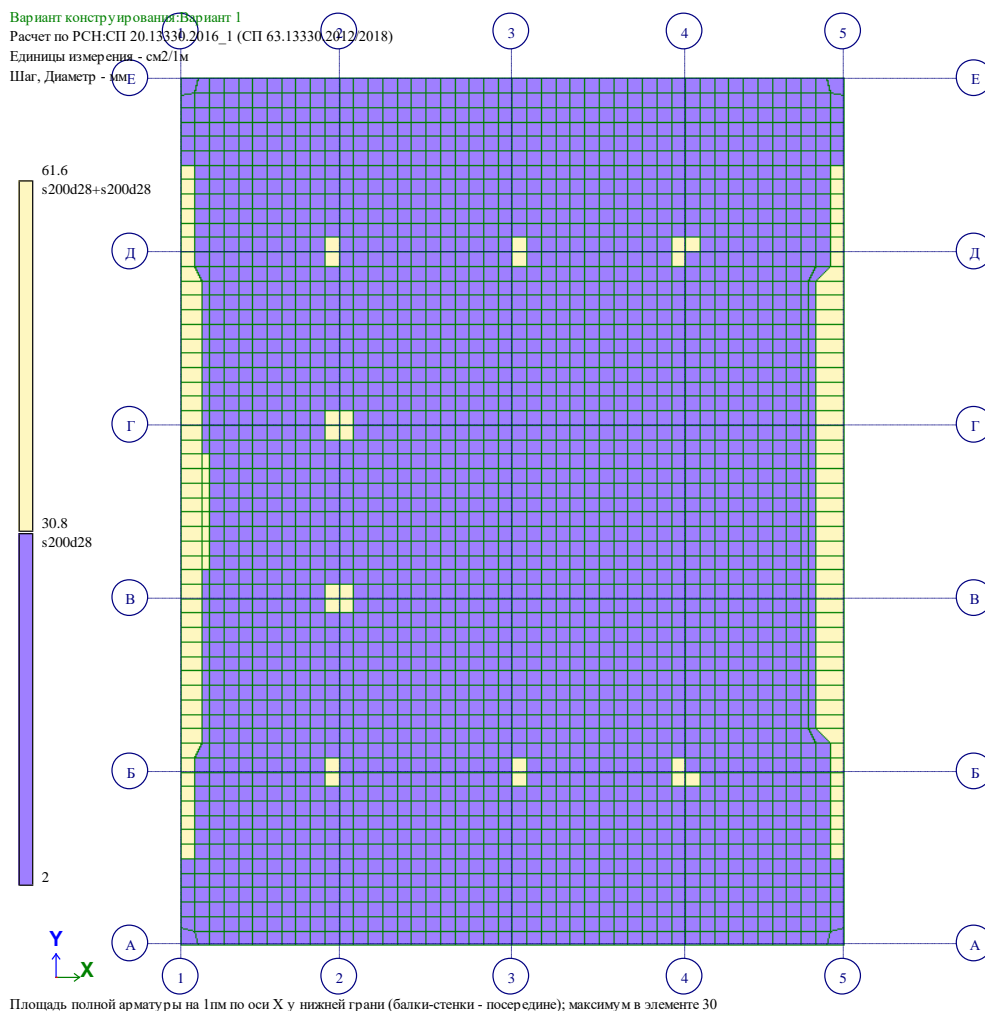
Изополя армирования – нижняя арматура по X
